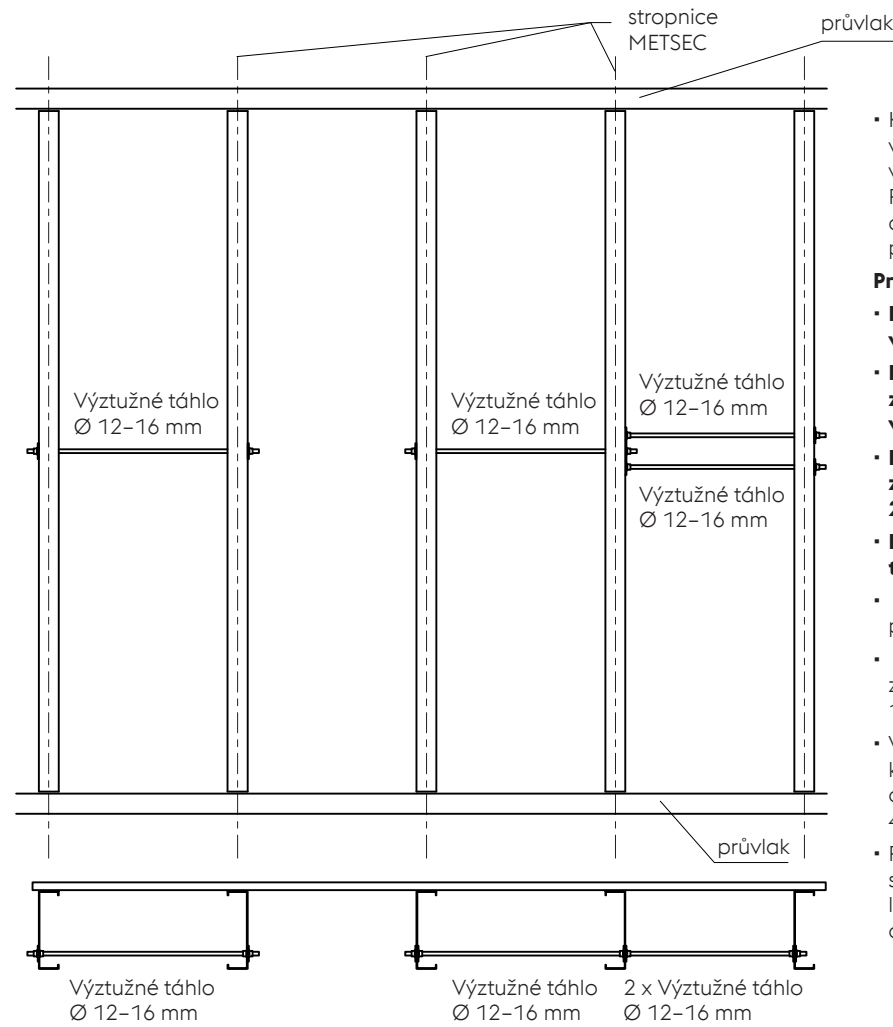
Schema umístění výztužných tyčí v případě sudého počtu stropnic
